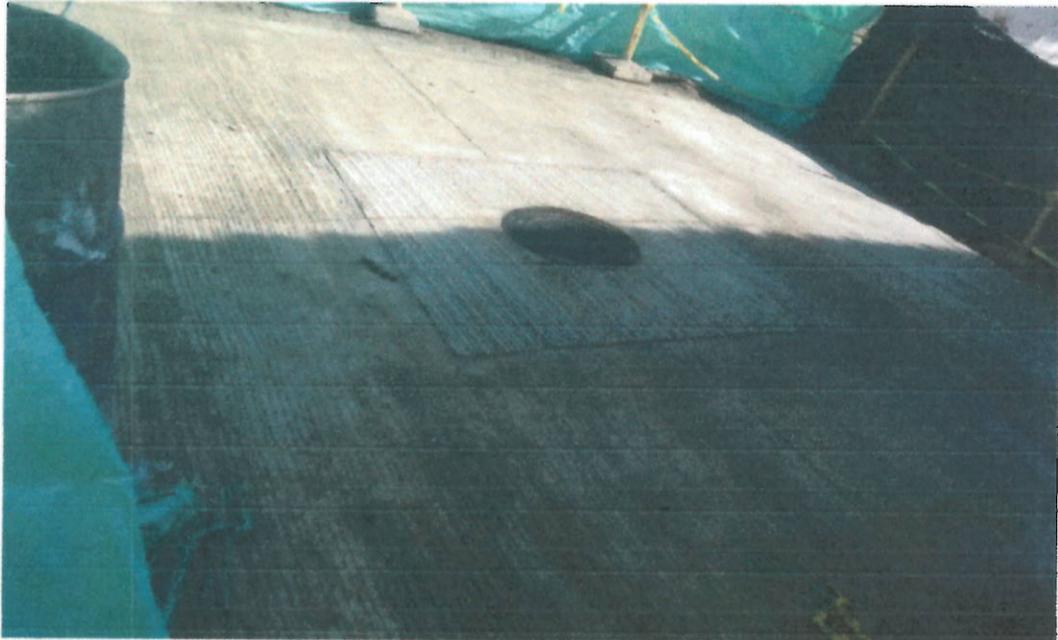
Vaciado de plato en intersección de la carrera 5 con calle 2 e instalación de taparao HF.
